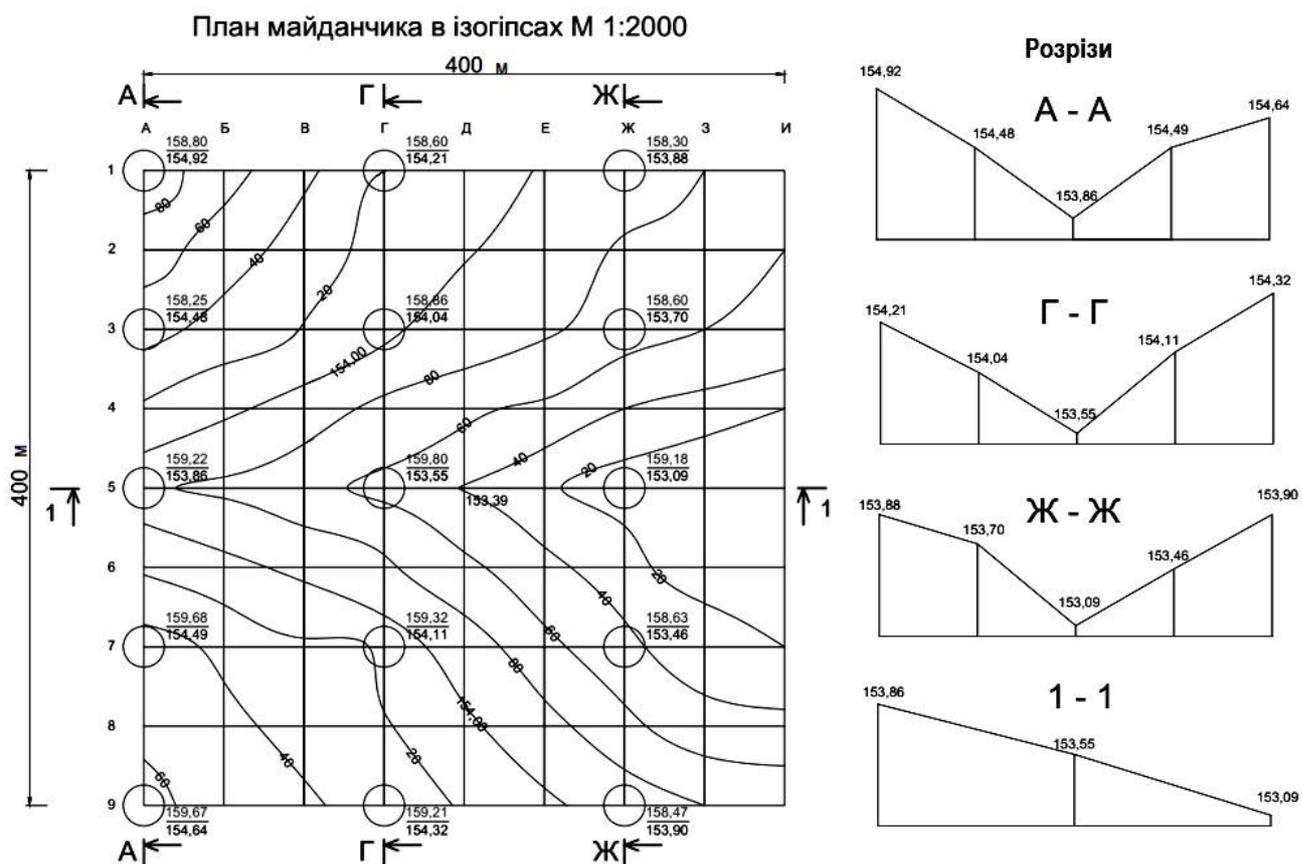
План майданчика в ізогісах з розрізами (приклад 2)
